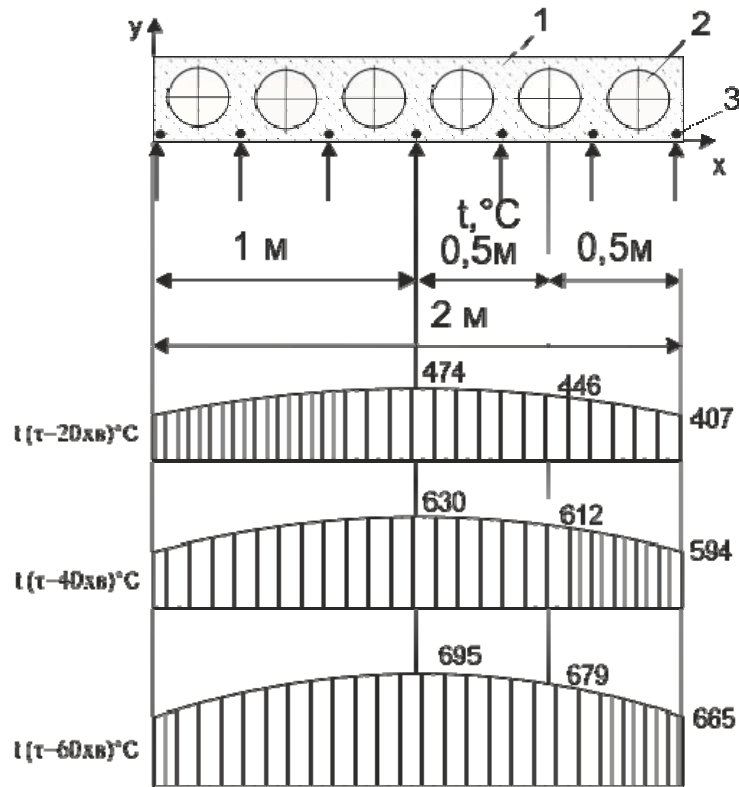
Епюра температури на арматурі ($y=0,02\text{м}$) залізобетонної плити перекриття на 20, 40 та 60 хв пожежі: 1 – бетон; 2 – пустоти; 3 - арматура
